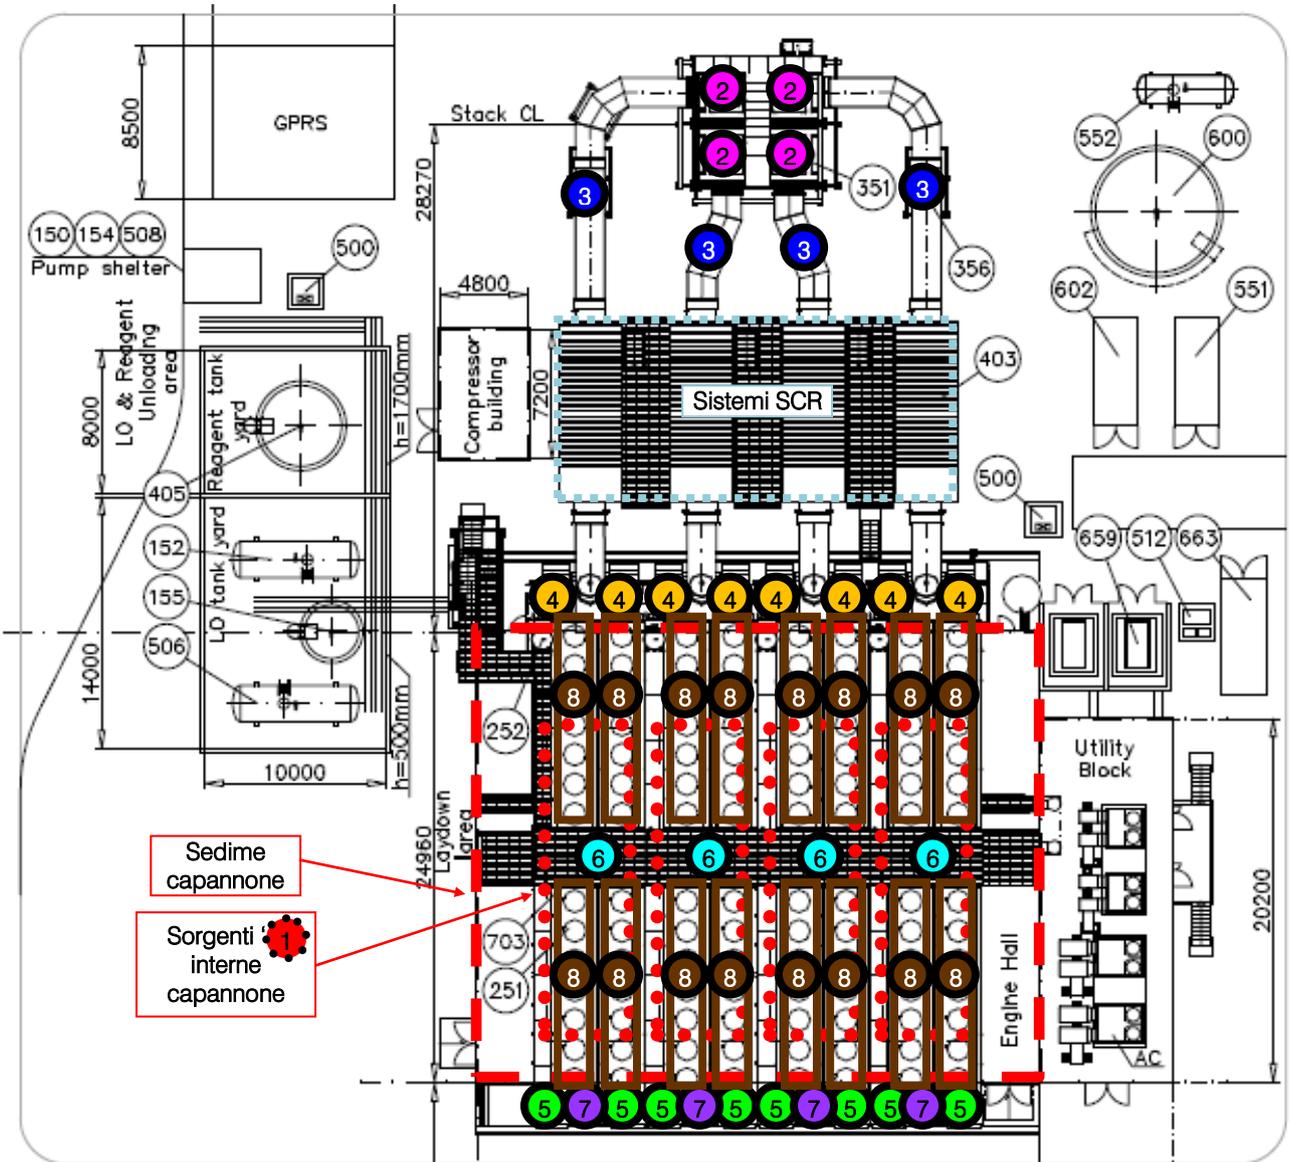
Planimetria della centrale in progetto con individuazione delle sorgenti sonore.
